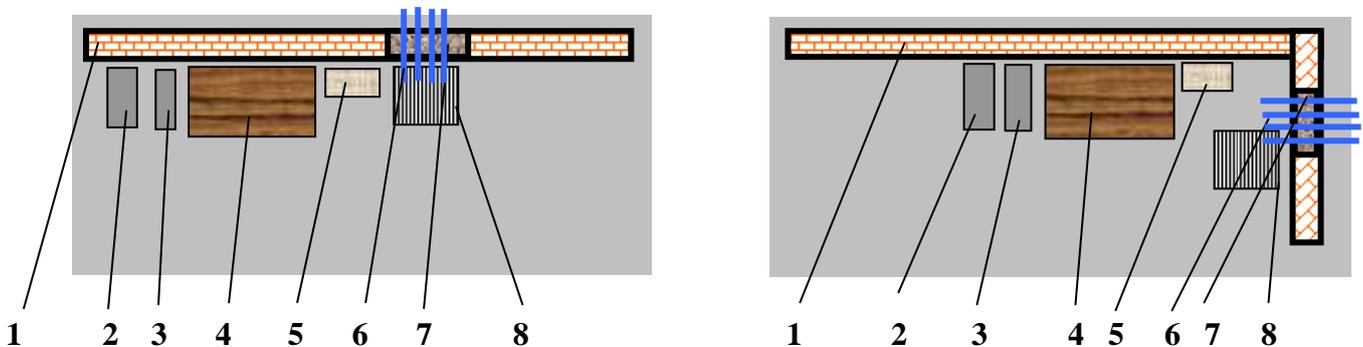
Схема организации рабочего места по установке системы вдоль стены и в углу помещения
